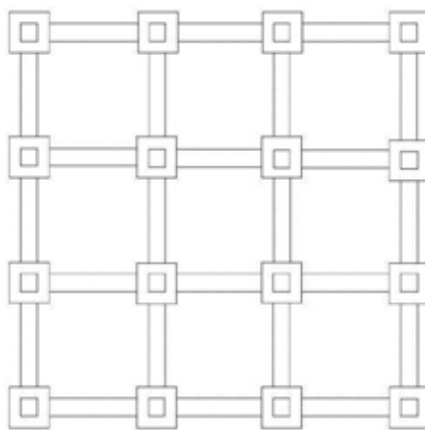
Planta de Fundaciones enlazadas con Vigas de Riostras
